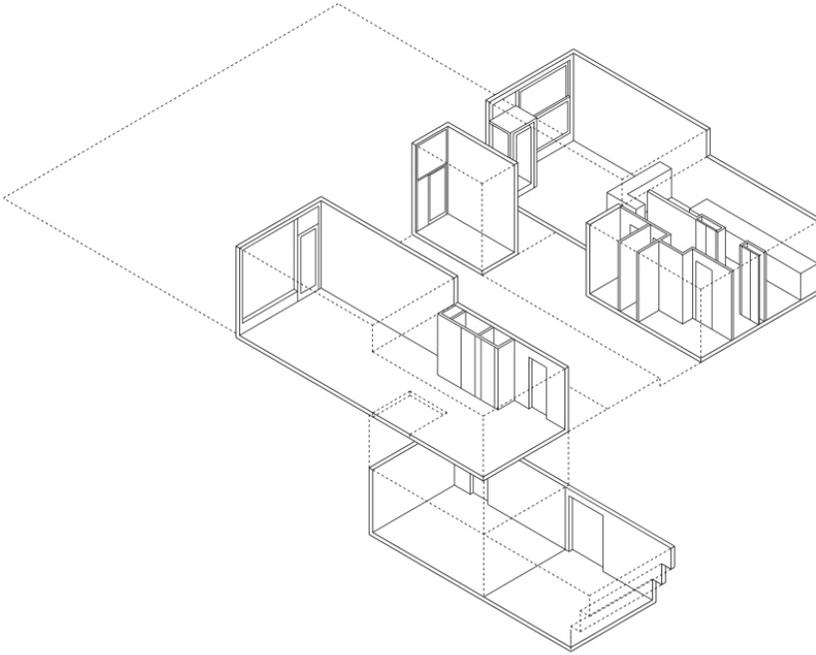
Mischen Possible, Grundriss EG mit Miniladen und Café
